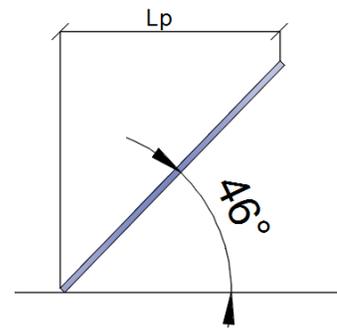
Schéma de disposition d'un panneau photovoltaïque sur le toit .Source : Auteur
